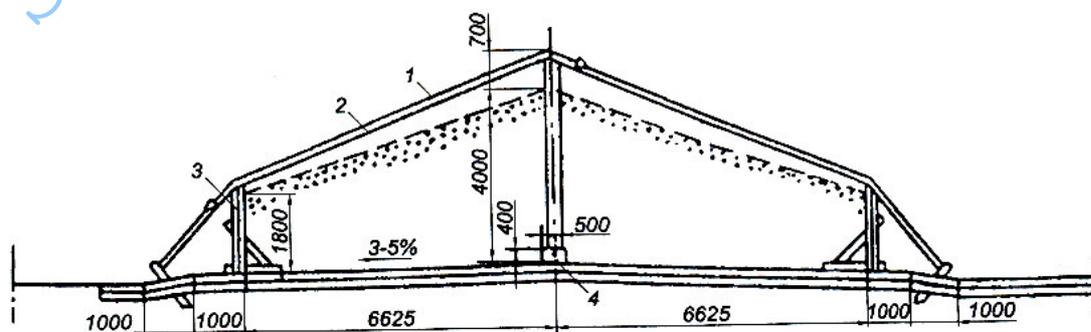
Типовой бунт для зерна со стенами из хлебных щитов:
